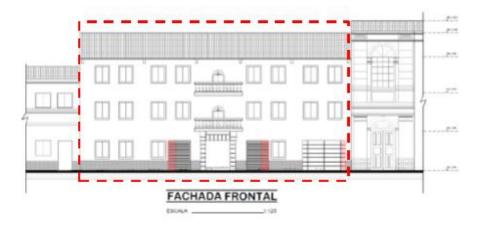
Fachada Estado Actual. Fuente: Planos Arquitectónicos, 2021.
